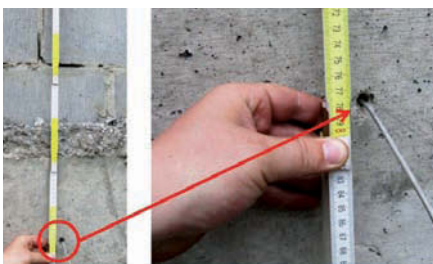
Widok elewacji po awarii ściany szczelinowej [3]
